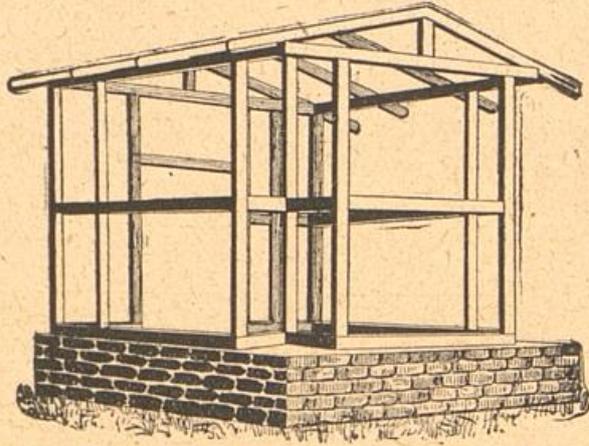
Gerüst eines 30 fächerigen Pavillons.
